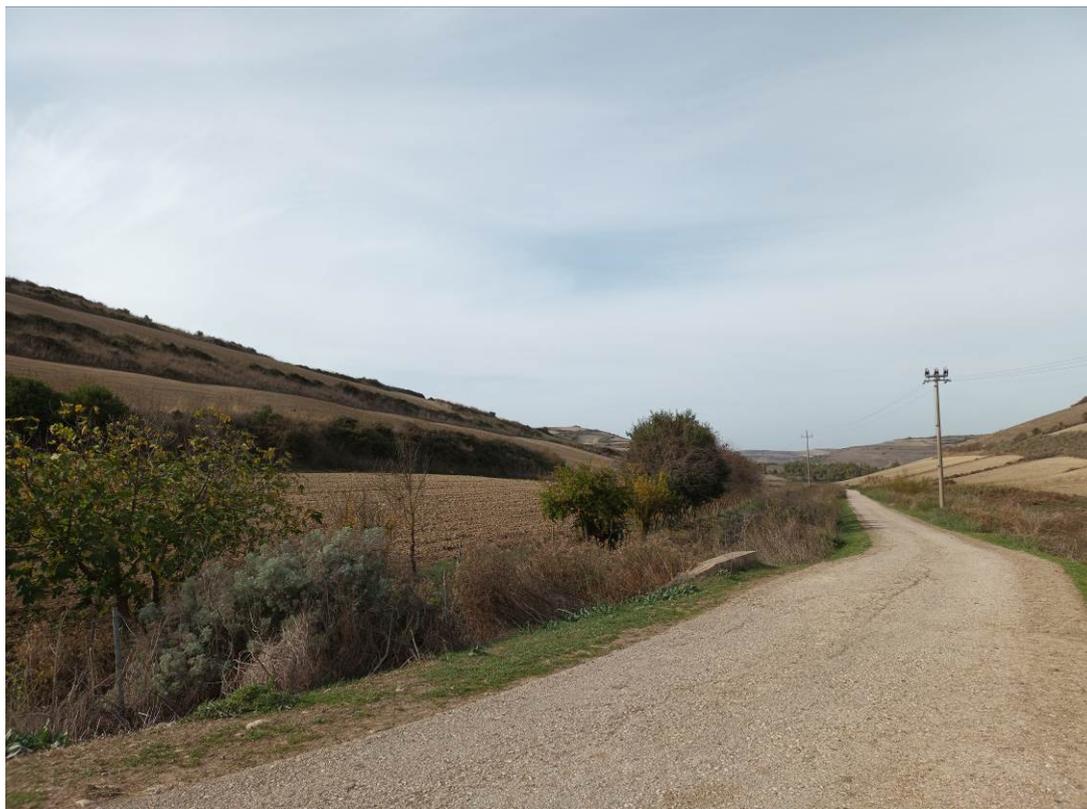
2: Vista della viabilità secondaria esistente nell'area di progetto
